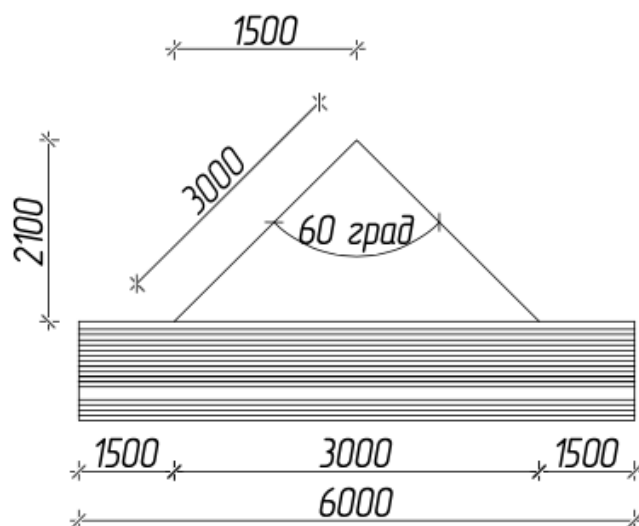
Расчет длины двухветвевго стропы для монтажа пучков арматуры и опалубки
